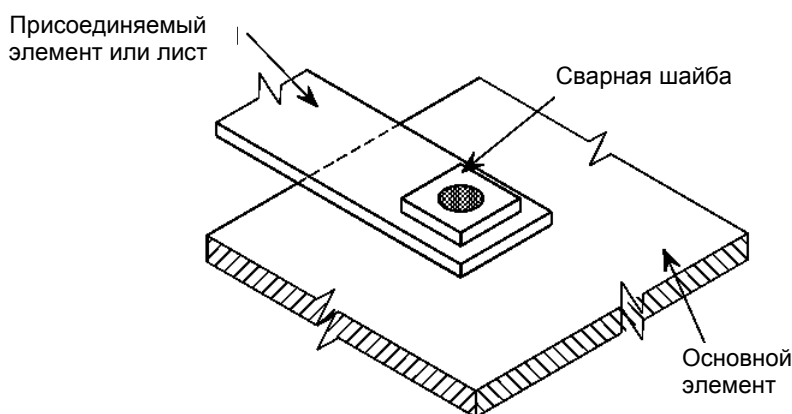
Дуговая точечная сварка со сварной шайбой
